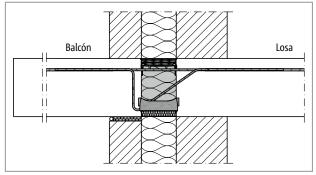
Schöck Isokorb® XT tipo K: Conexión para muro doble con núcleo aislante
